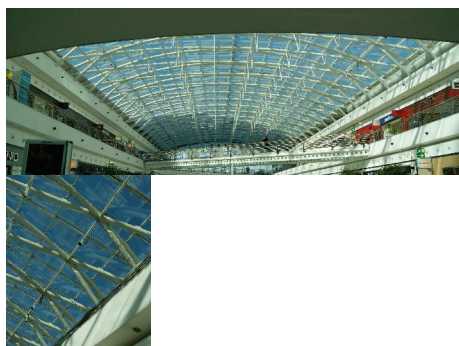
Cobertura envidraçada, vista interior e exterior
